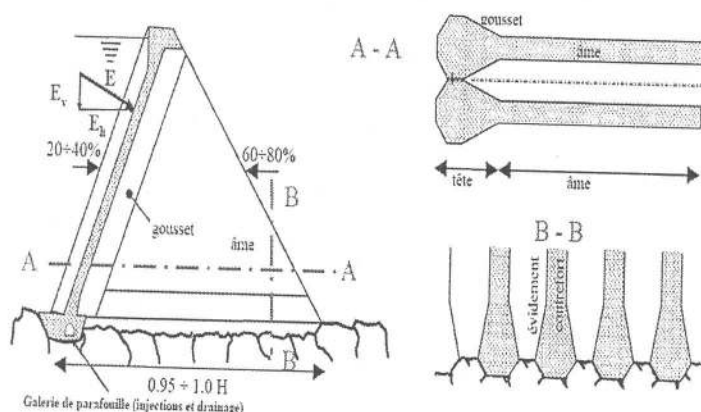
Barrage à contreforts: profil type et section horizontale
